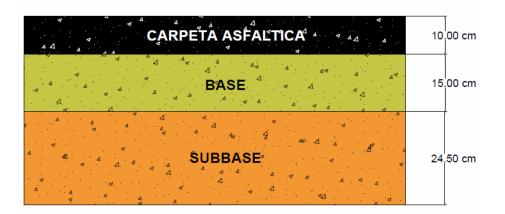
Espesores del diseño de pavimento flexible – Avenida Central.
